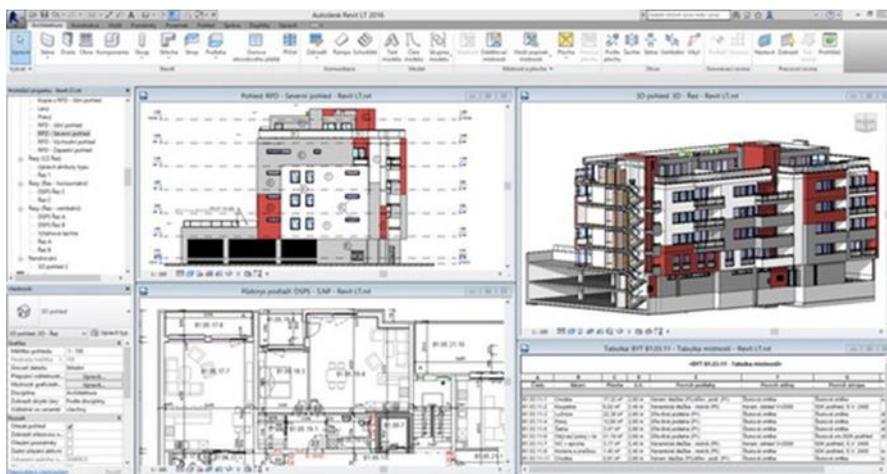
Работа над виртуальной моделью зданий с использованием BIM
